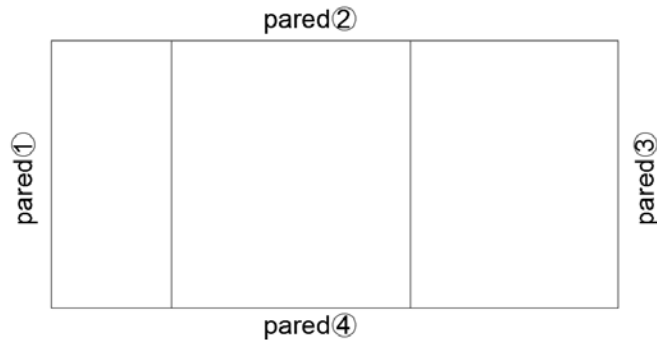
Vista en planta del edificio – designación de paredes
